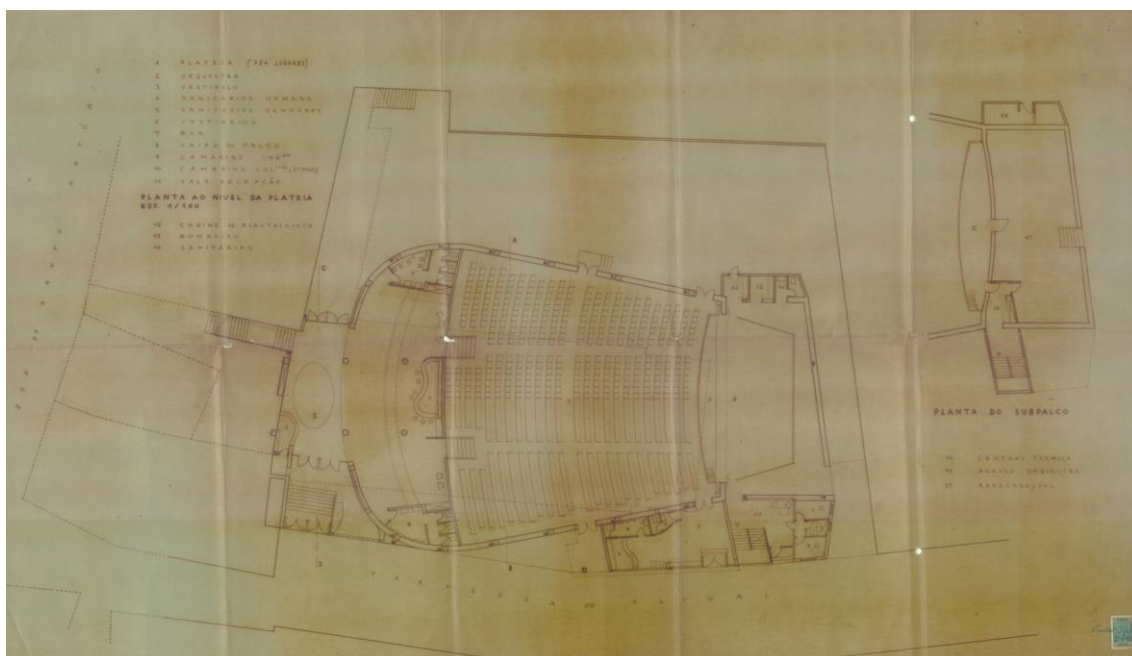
Planta ao nível da plateia, projeto de Nadir Afonso.
